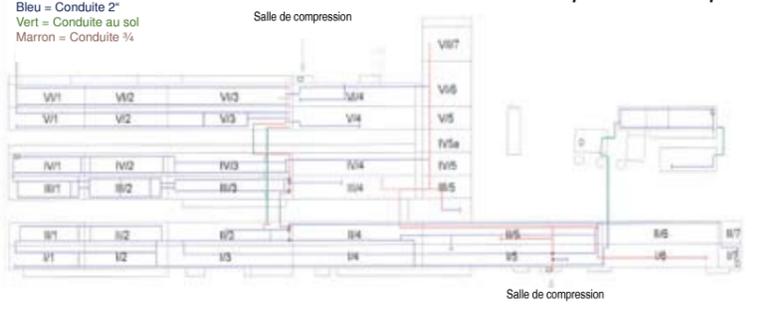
Plan d'ensemble de la conduite principale d'air comprimé d'une entreprise
